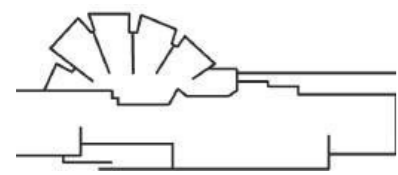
Planta esquemática da biblioteca Rovaniemi City.
